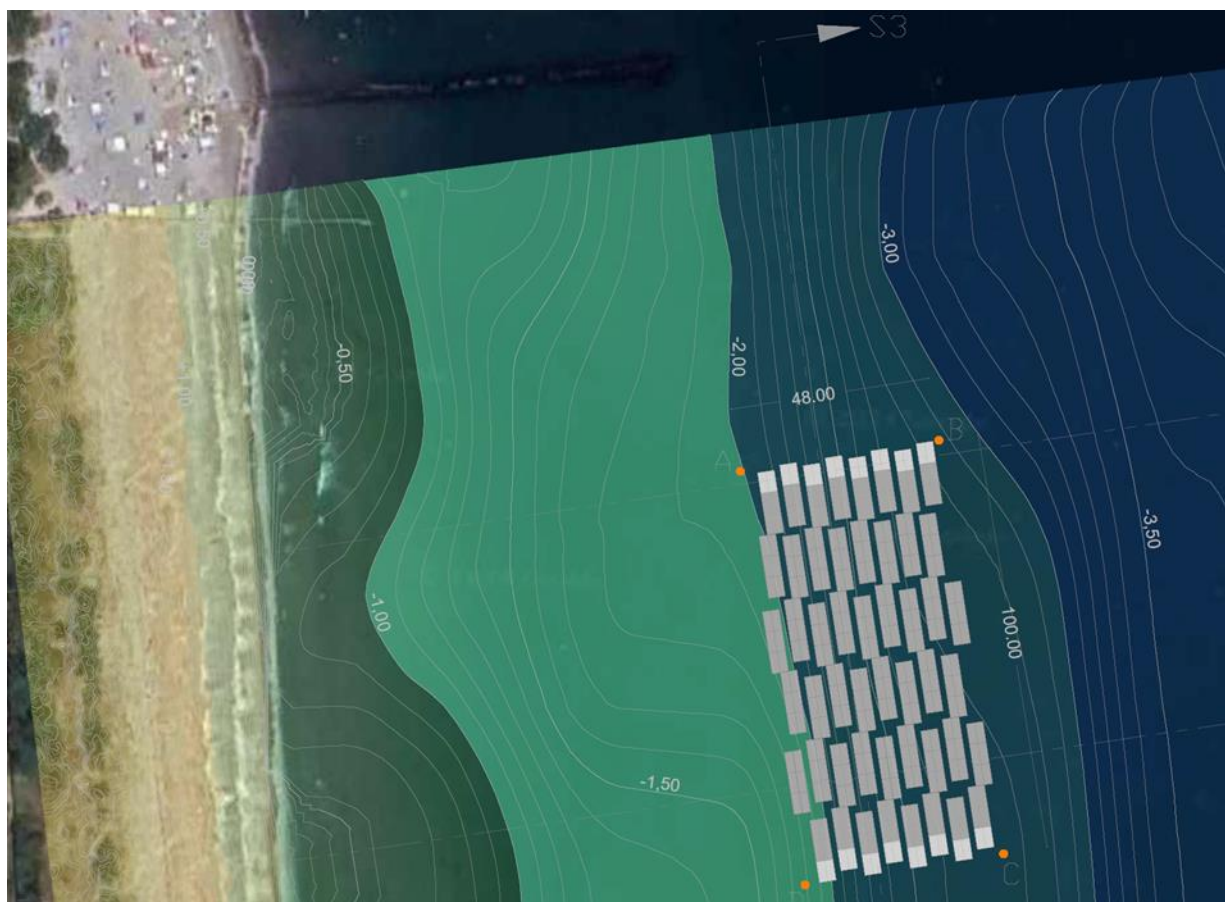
ALTERNATIVA 2 - Planimetria di progetto.
